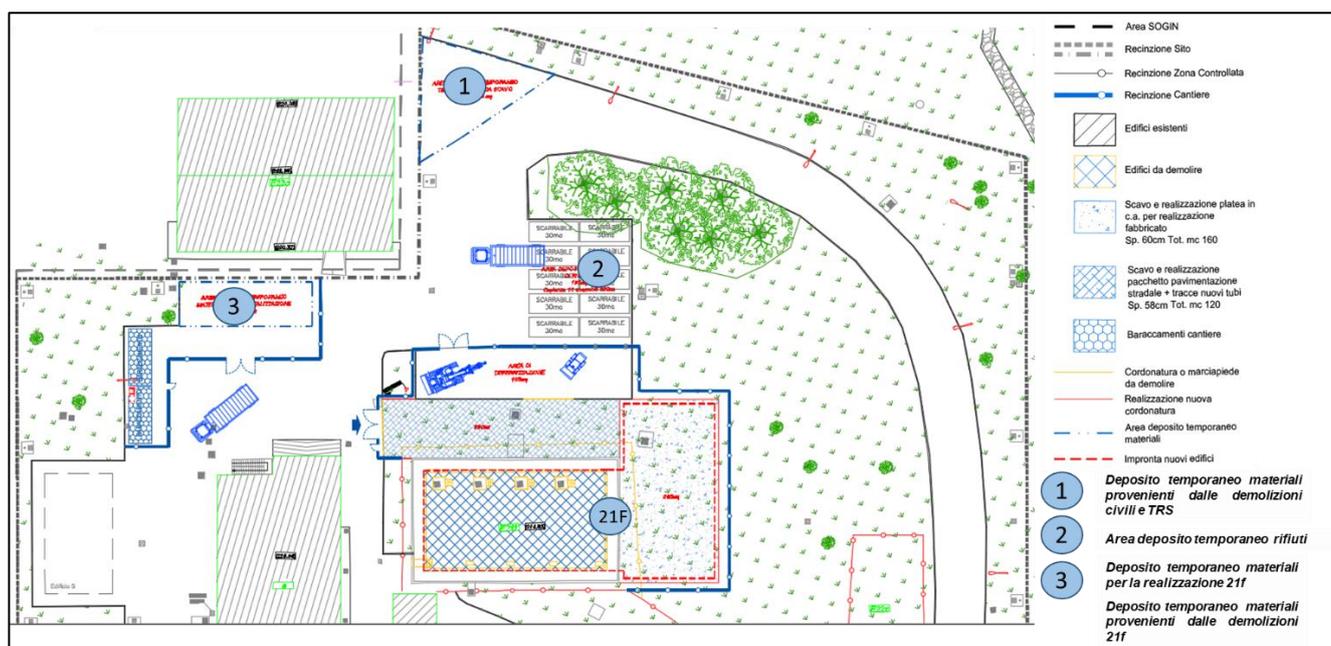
Smantellamento edificio 21F – Cantierizzazione
